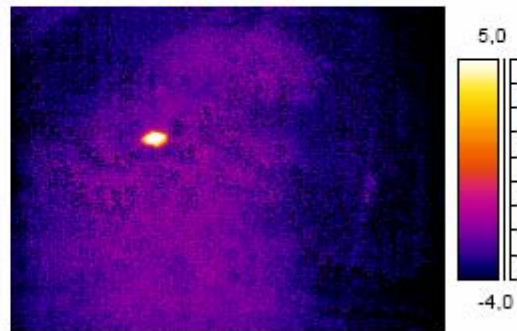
Dachterrasse mit Kiesschüttung und Dachablauf.
